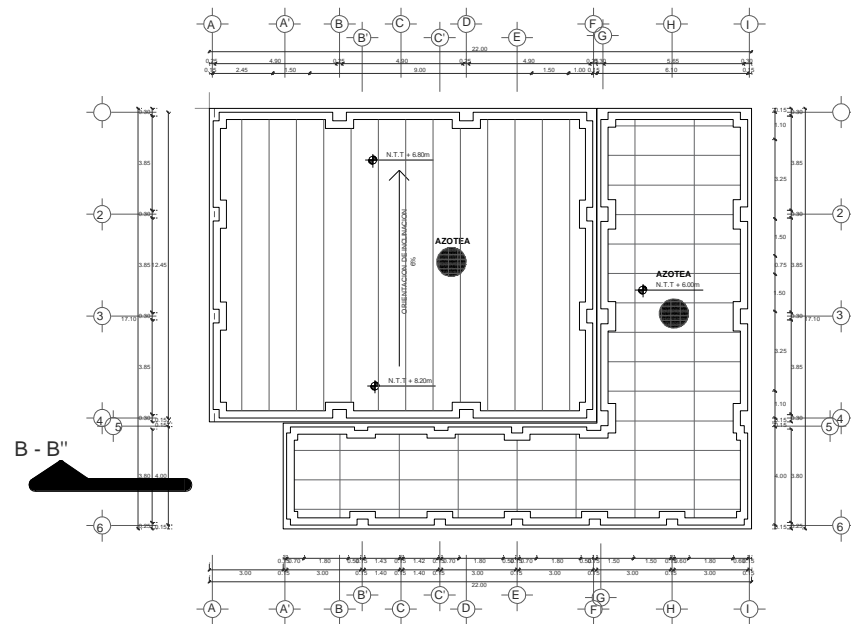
Plano de techos - Zona de Serv. Complementarios (SUM) - Bloque 04. Elaboración propia.
